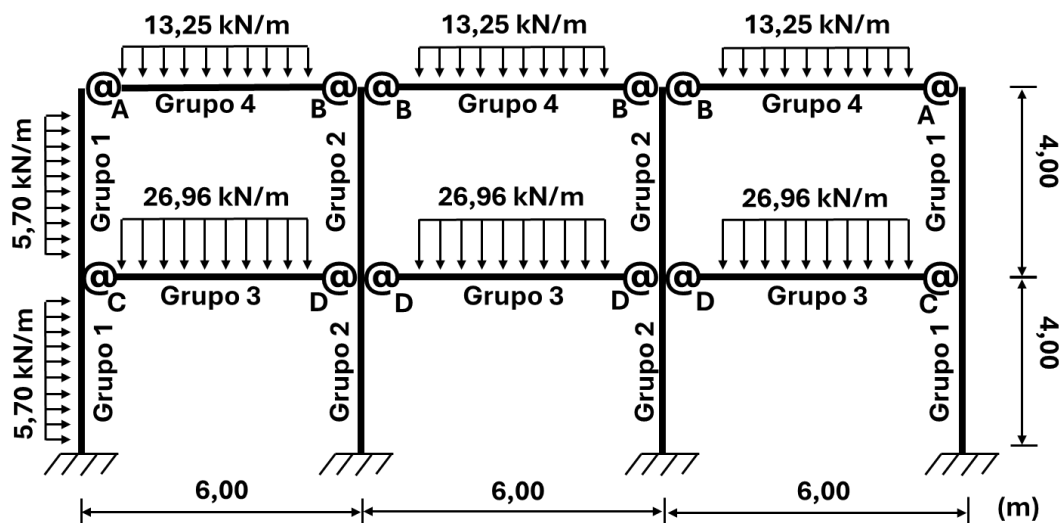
Pórtico plano de 2 andares e 3 vãos - 2a3v.
